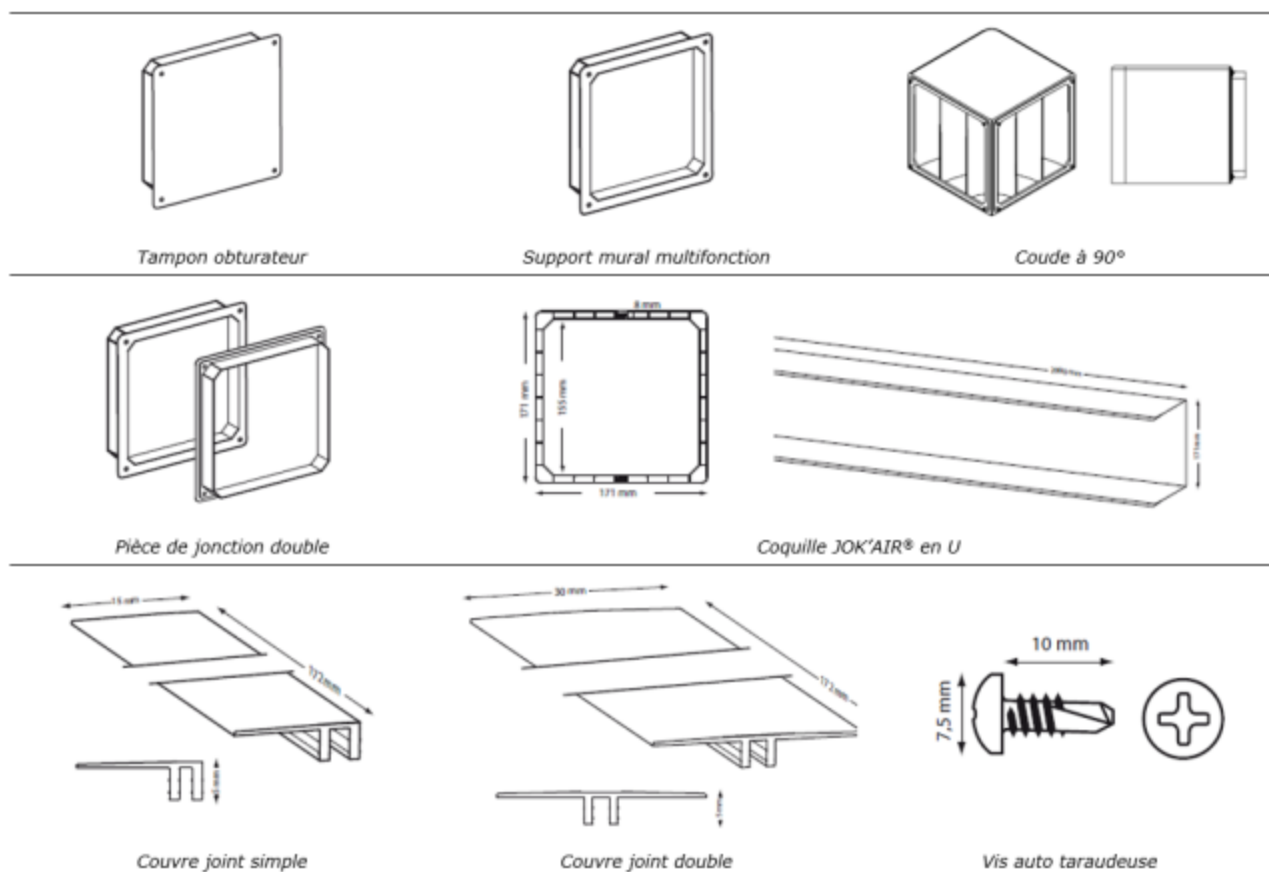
Conduits horizontaux JOK'AIR® – Éléments constitutifs
